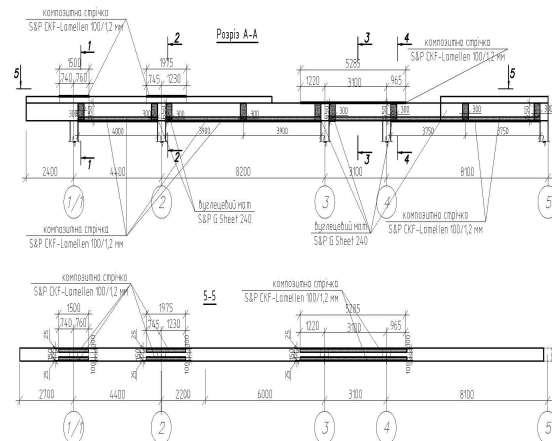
Посилення залізобетонного перехресно-ребристого перекриття на відм. +11.880 в осях 1-5, В-Г
